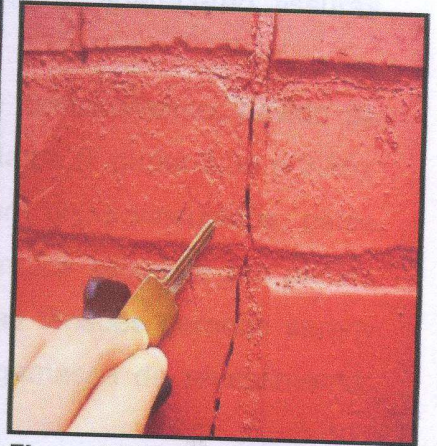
Fissuras verticais com abertura variando de 2mm. (ROCHA, 2008).
